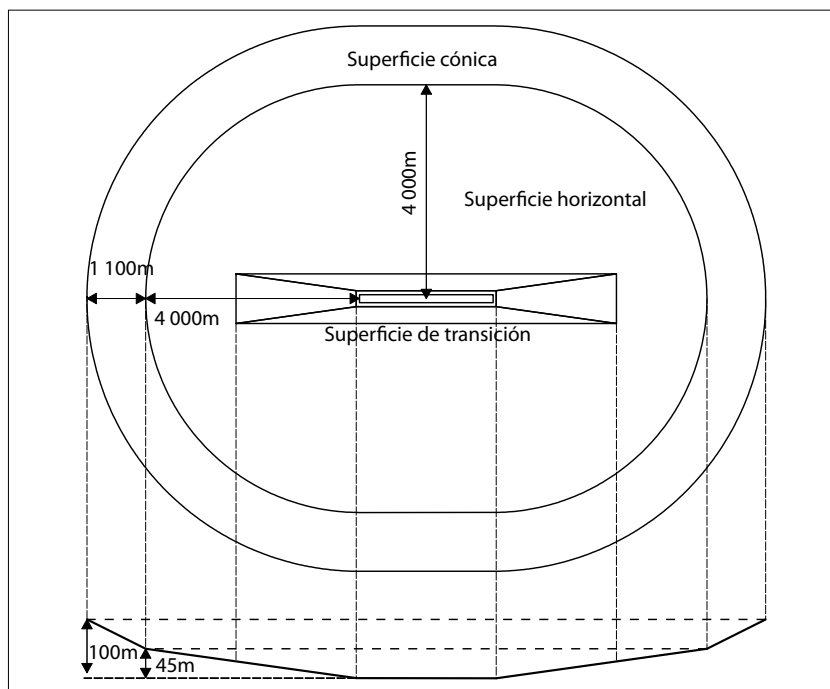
Vista en planta y de perfil de las superficies de transición, horizontal interna y cónica.
